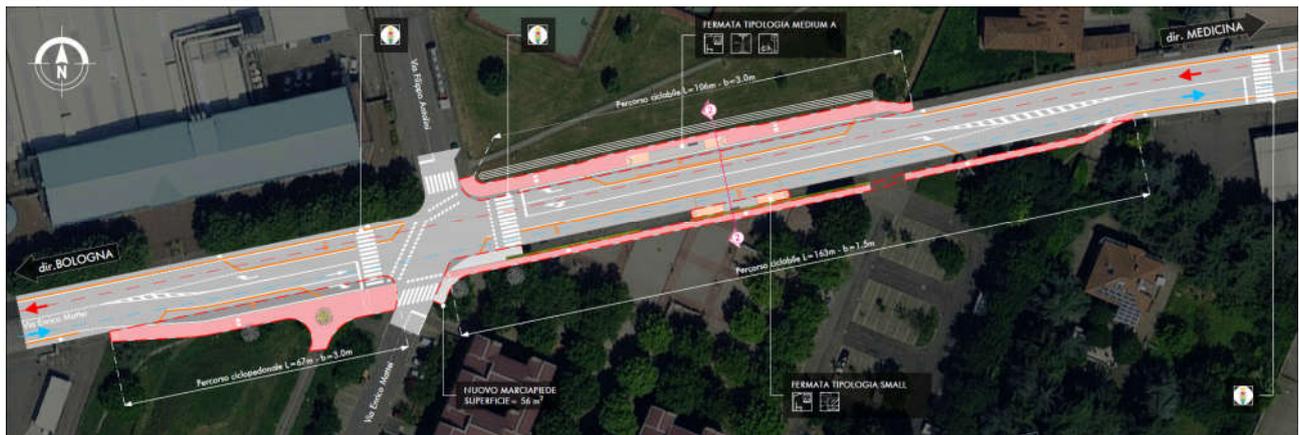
Fermata Piazza dei Colori. Planimetria.
